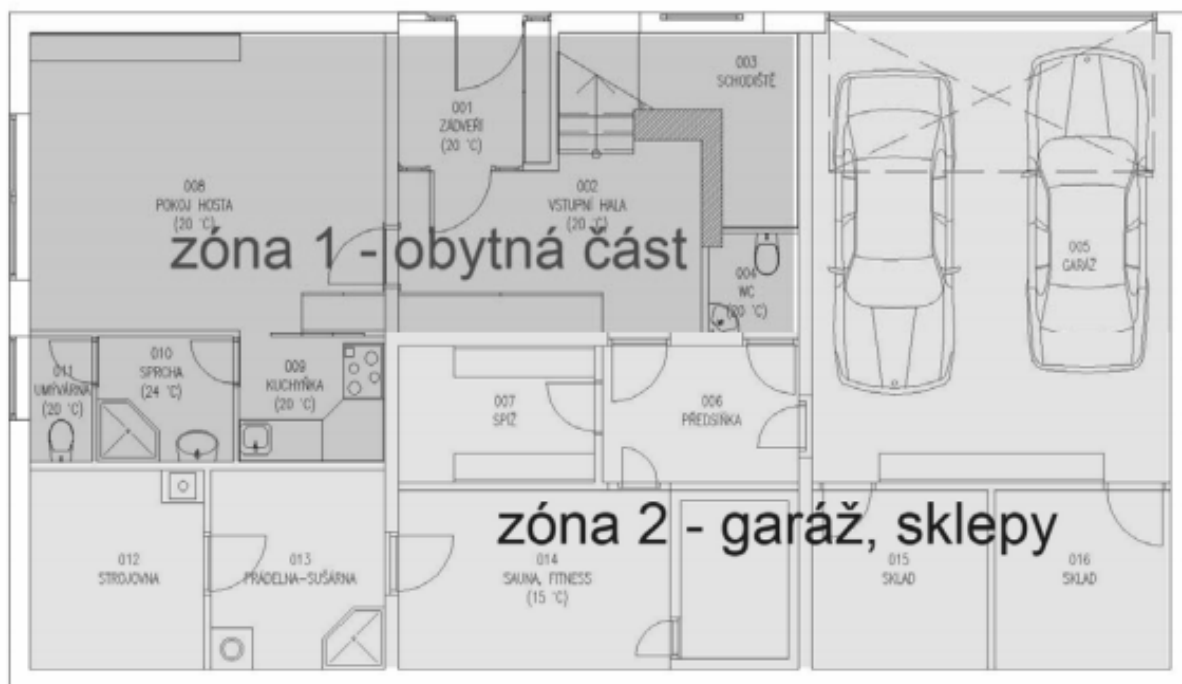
Haus Nr. 1006 Einfamilienhaus mit Solarkollektor EG, Grundriss [19i]
